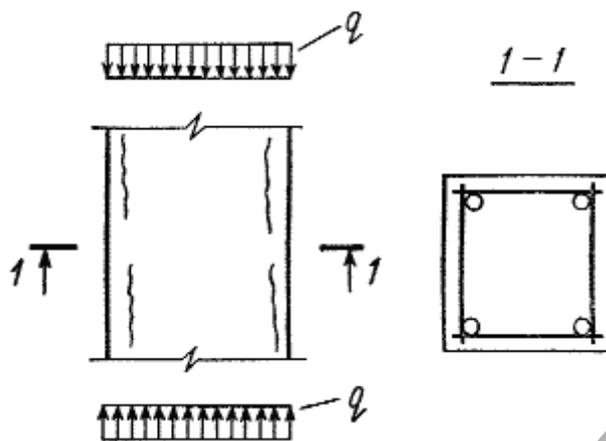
Трещины вдоль продольной арматуры в сжатых элементах [4]
